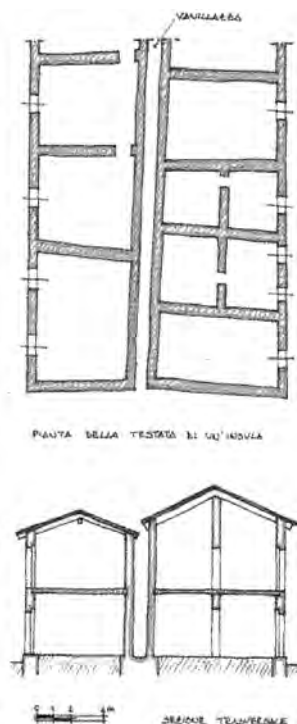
In alto è riportata la pianta di un'insula; in basso, la sezione trasversale
